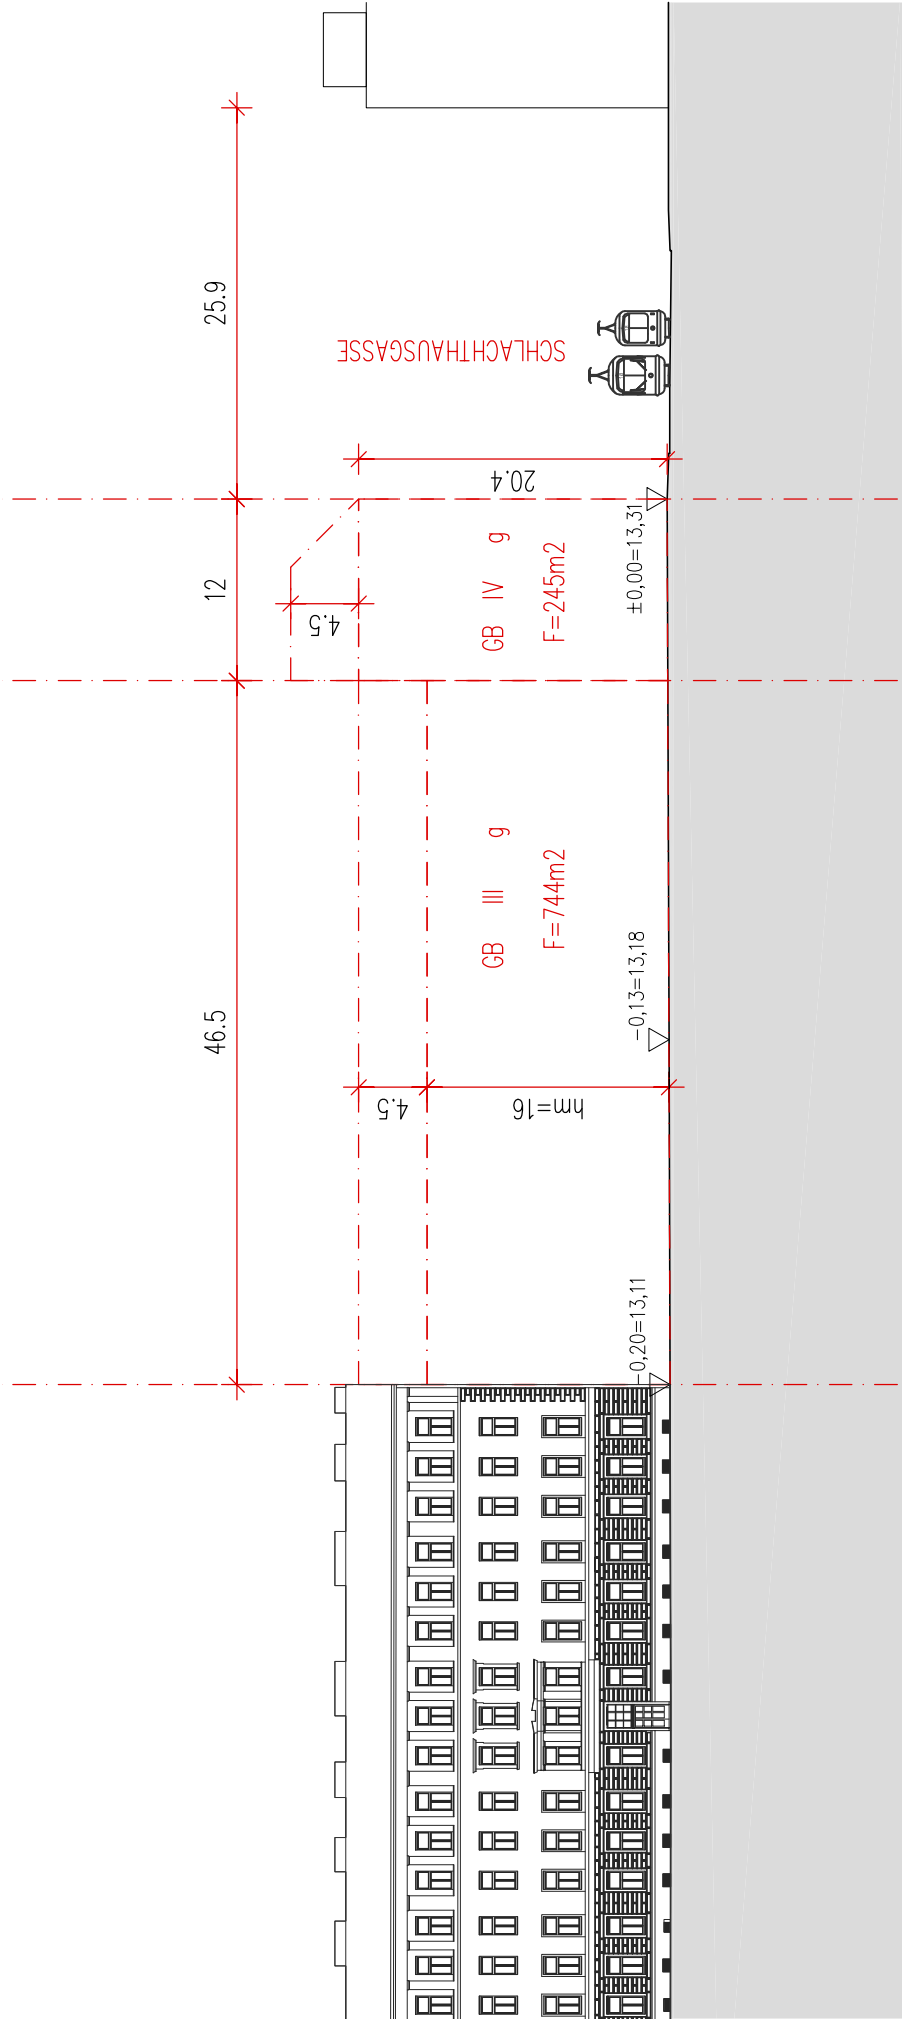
Ansicht Paulusgasse, Bebaubarkeit gemäß Flächenwidmungsplan 1998. M 1:500.
